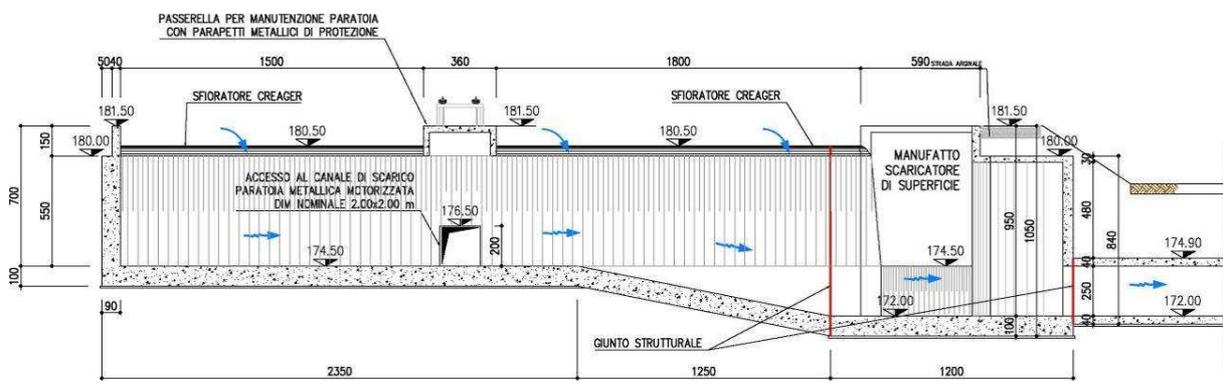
Sezione longitudinale in asse al ramo di scarico del manufatto di sfioro
